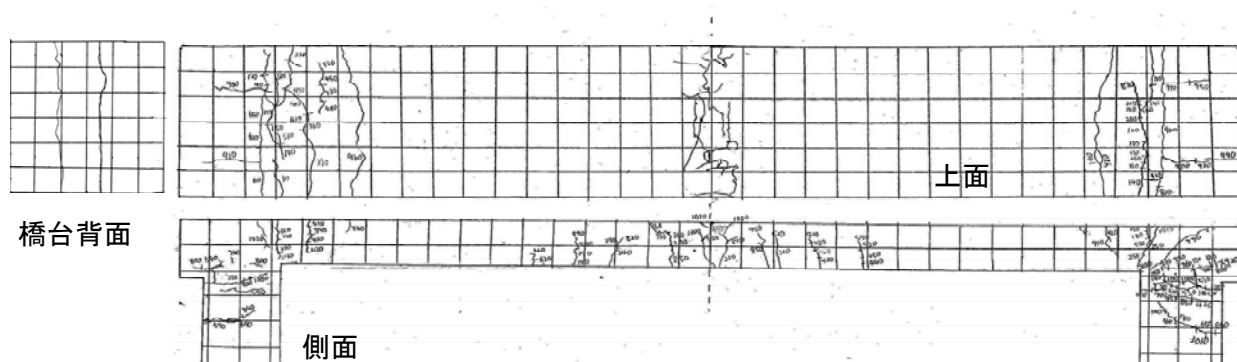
ラーメン構造試験体のひび割れ図
